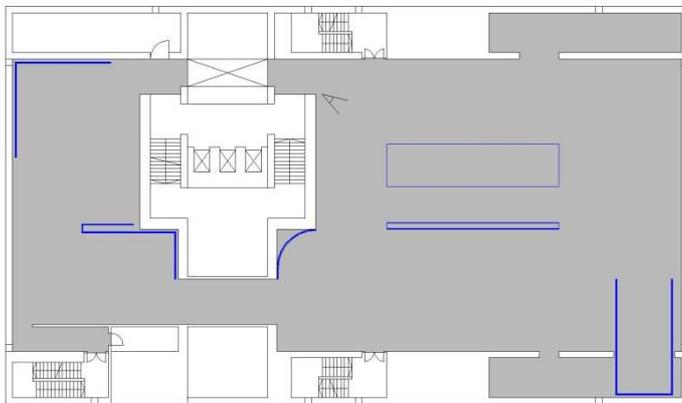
+191: Ausstellungsgrundriss und -ansicht, Wien
